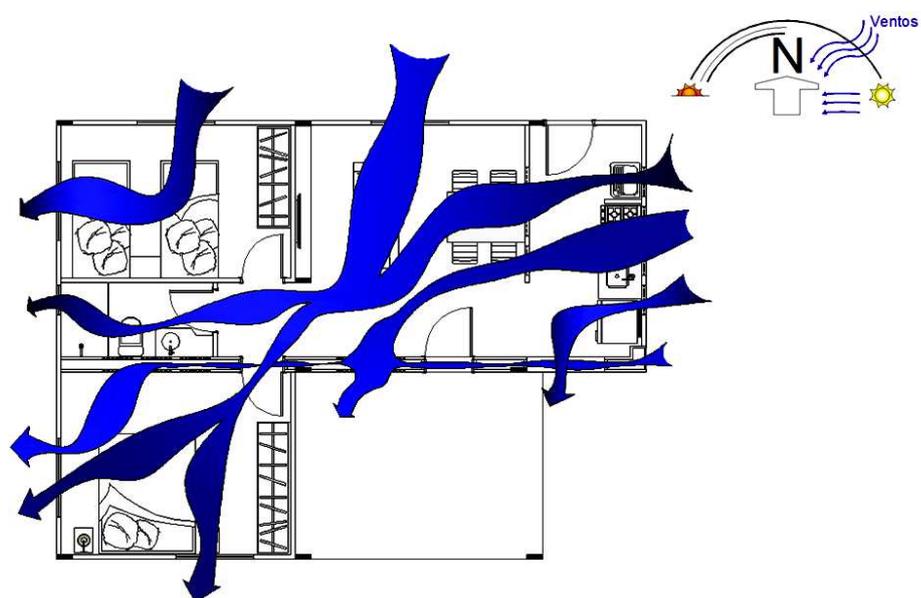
Planta Baixa Desfavorável - Estudo de ventilação cruzada.
